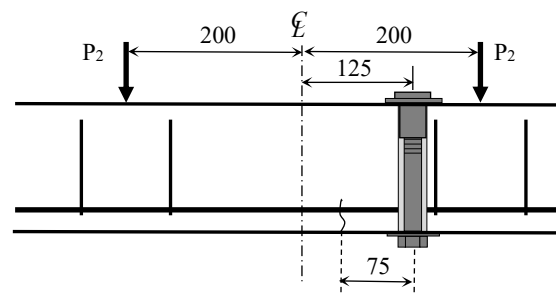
試験体 3 の圧縮力導入位置・ひび割れの位置
